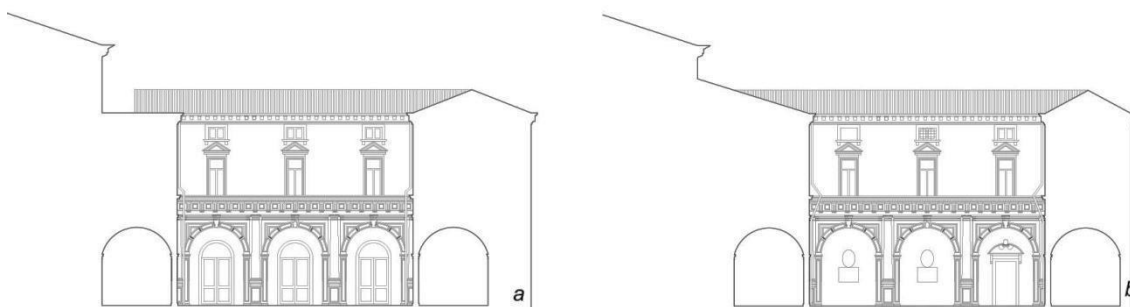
prospetti del chiostro dorico interno: a) prospetto occidentale; b) prospetto nord
